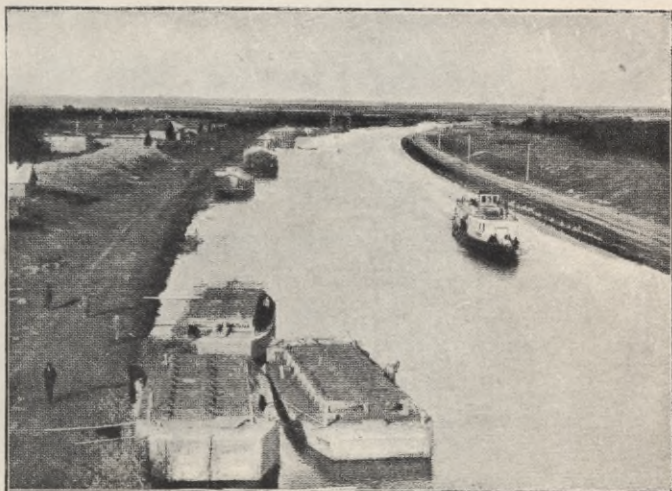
Kanal des Kaisers Alexander des II in Schlüsselburg.
